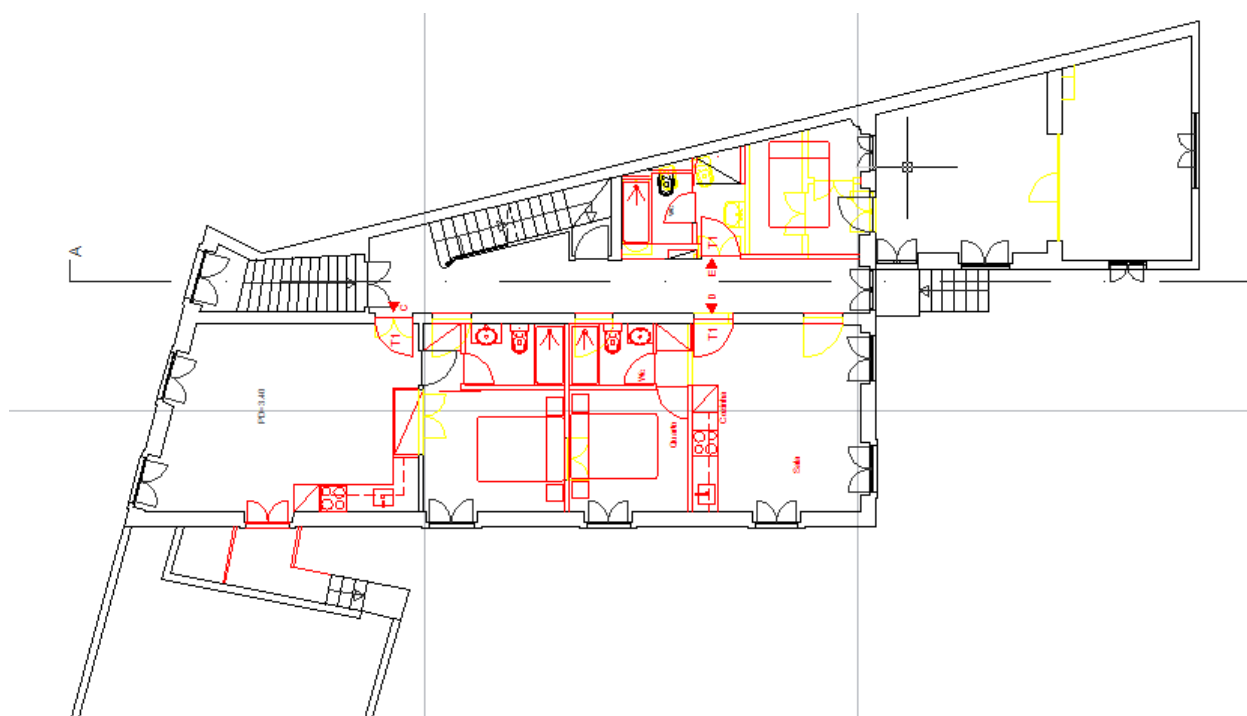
Planta de vermelhos e amarelos do 1º andar
